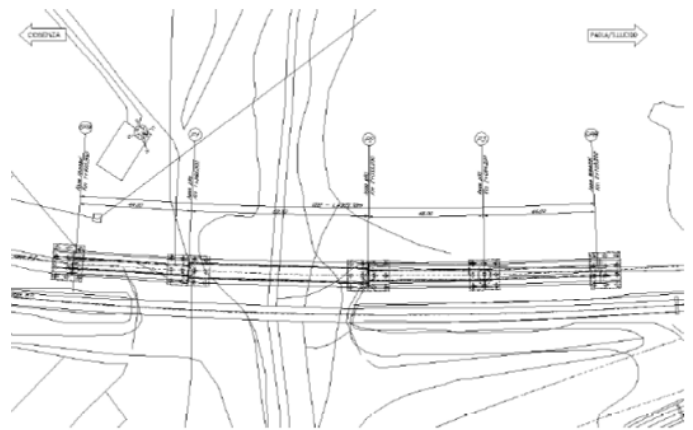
Planimetria del viadotto ferroviario VI02b
